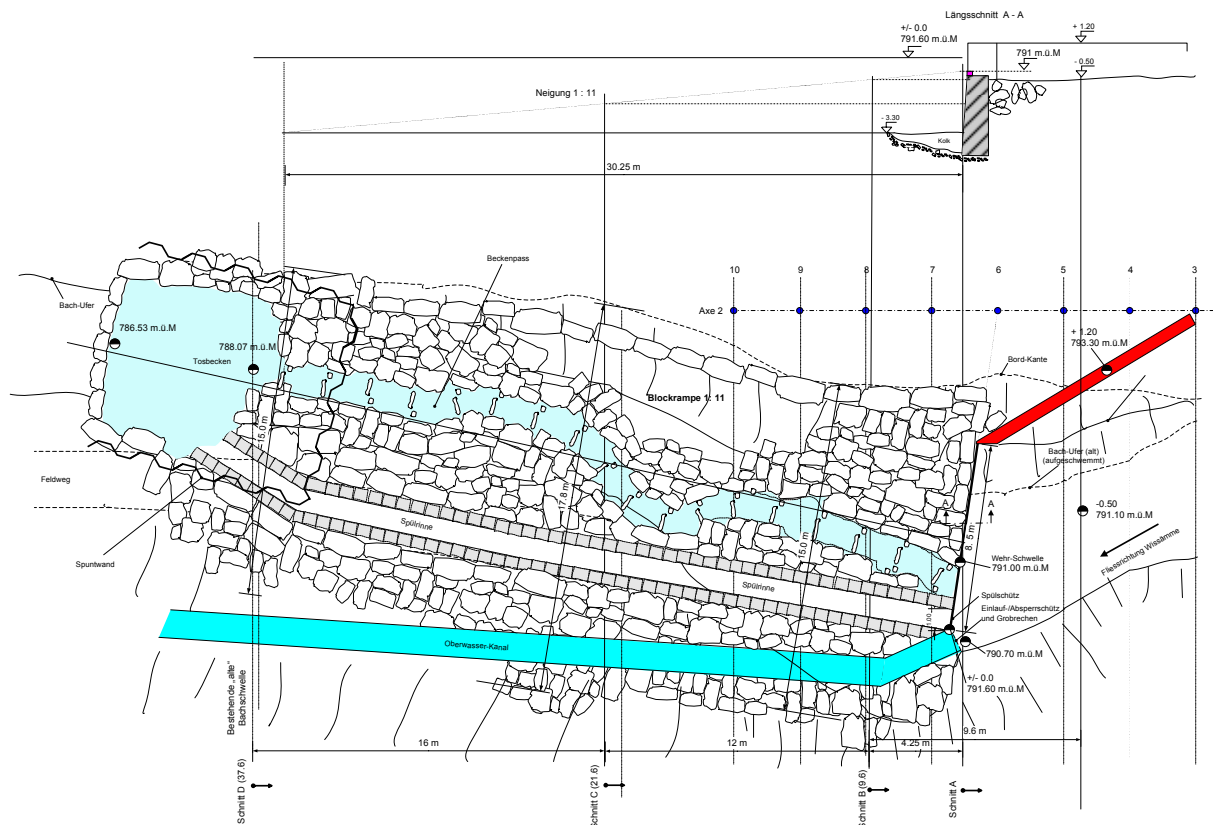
Grundriss der Blockrampe mit integrierter FAH und Spülrinne
